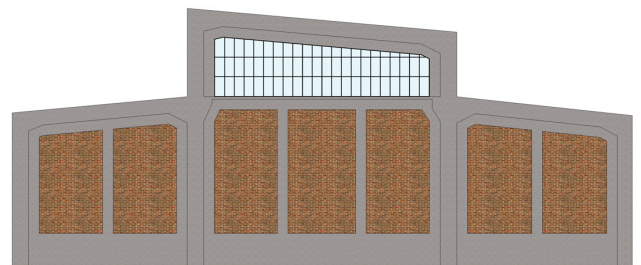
Elaboración propia a partir de planimetría original Casa de Máquinas de Temuco y medidas tomadas en terreno
